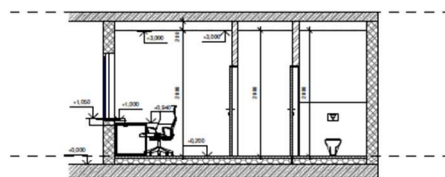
Příklad zázemí dopravce s jednou pokladní přepážkou
